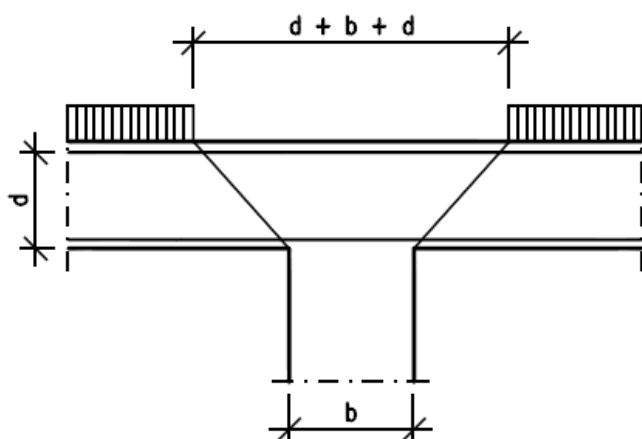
Pilarilaatan lävistysmurtopinta [9, 67]
